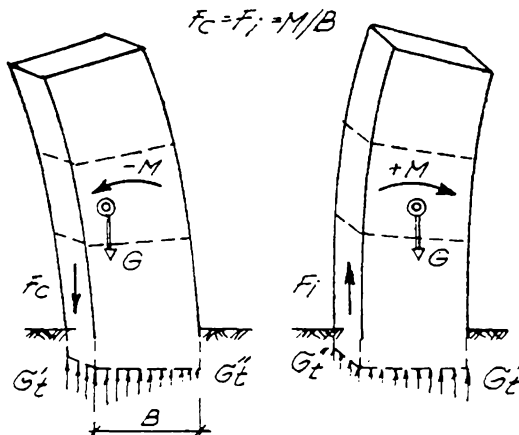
Efectul oscilațiilor la modul fundamental asupra planurilor structurale verticale perimetrare.
